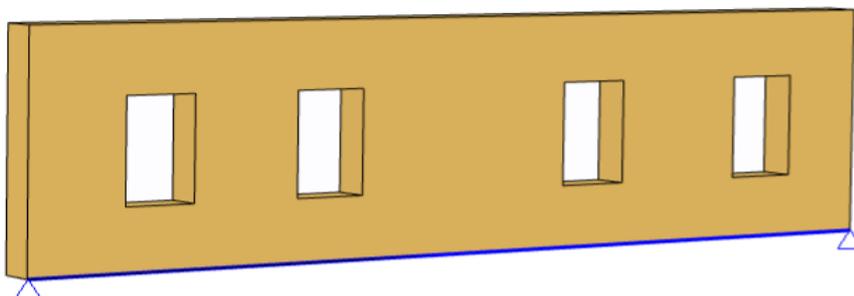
Modello numerico locale prospetto nord-ovest piano secondo
